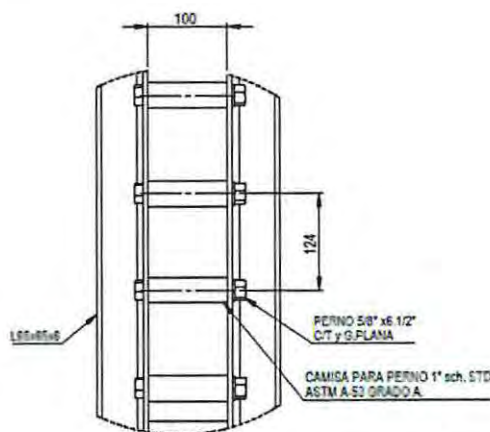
Leyton, E. (2007). Plano de cremallera ascensor Larrain.
